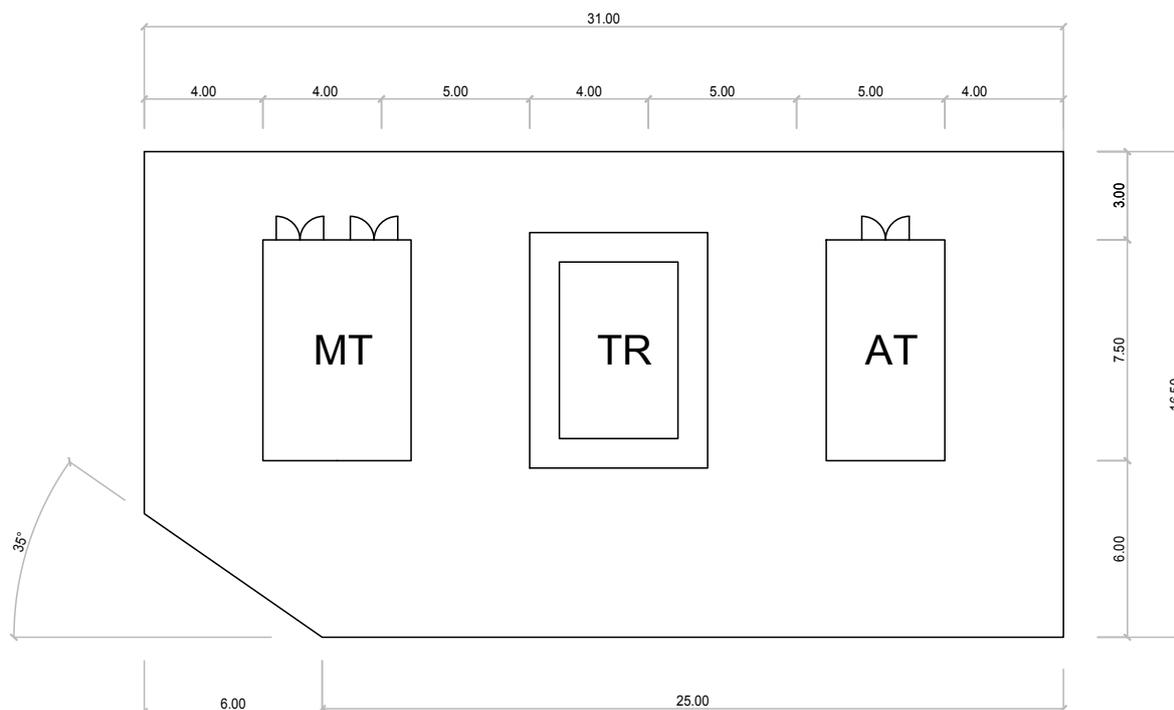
Platea di fondazione dell'area di trasformazione e disposizione cabine
